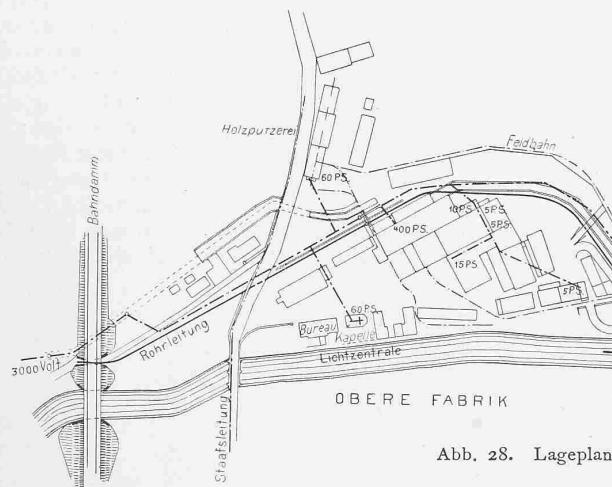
Lageplan der Papierfabrik Albruck. — Masstab 1 : 5000.
